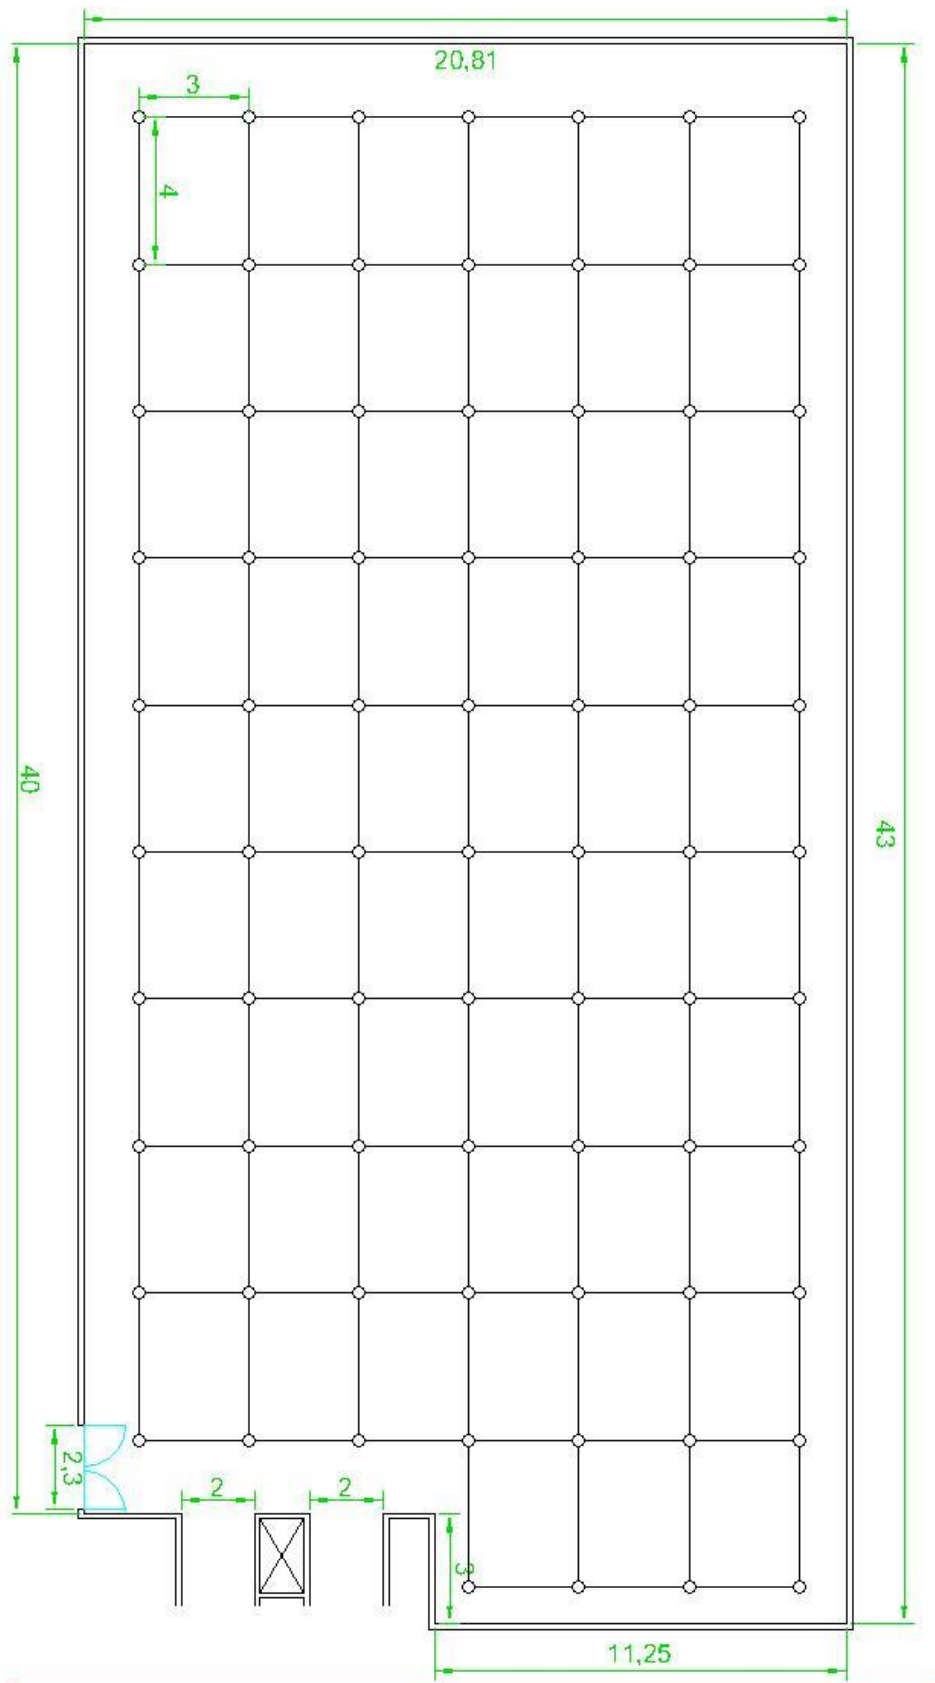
Arranjo do sistema de *sprinklers* do pavimento 2
